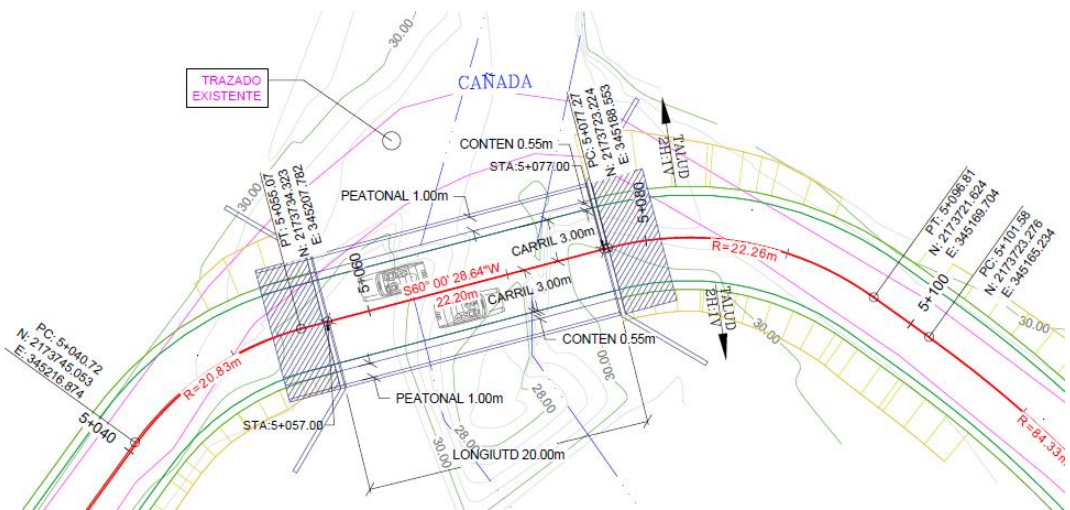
Planta dimensionada del nuevo puente sobre el Arroyo Aguacate
